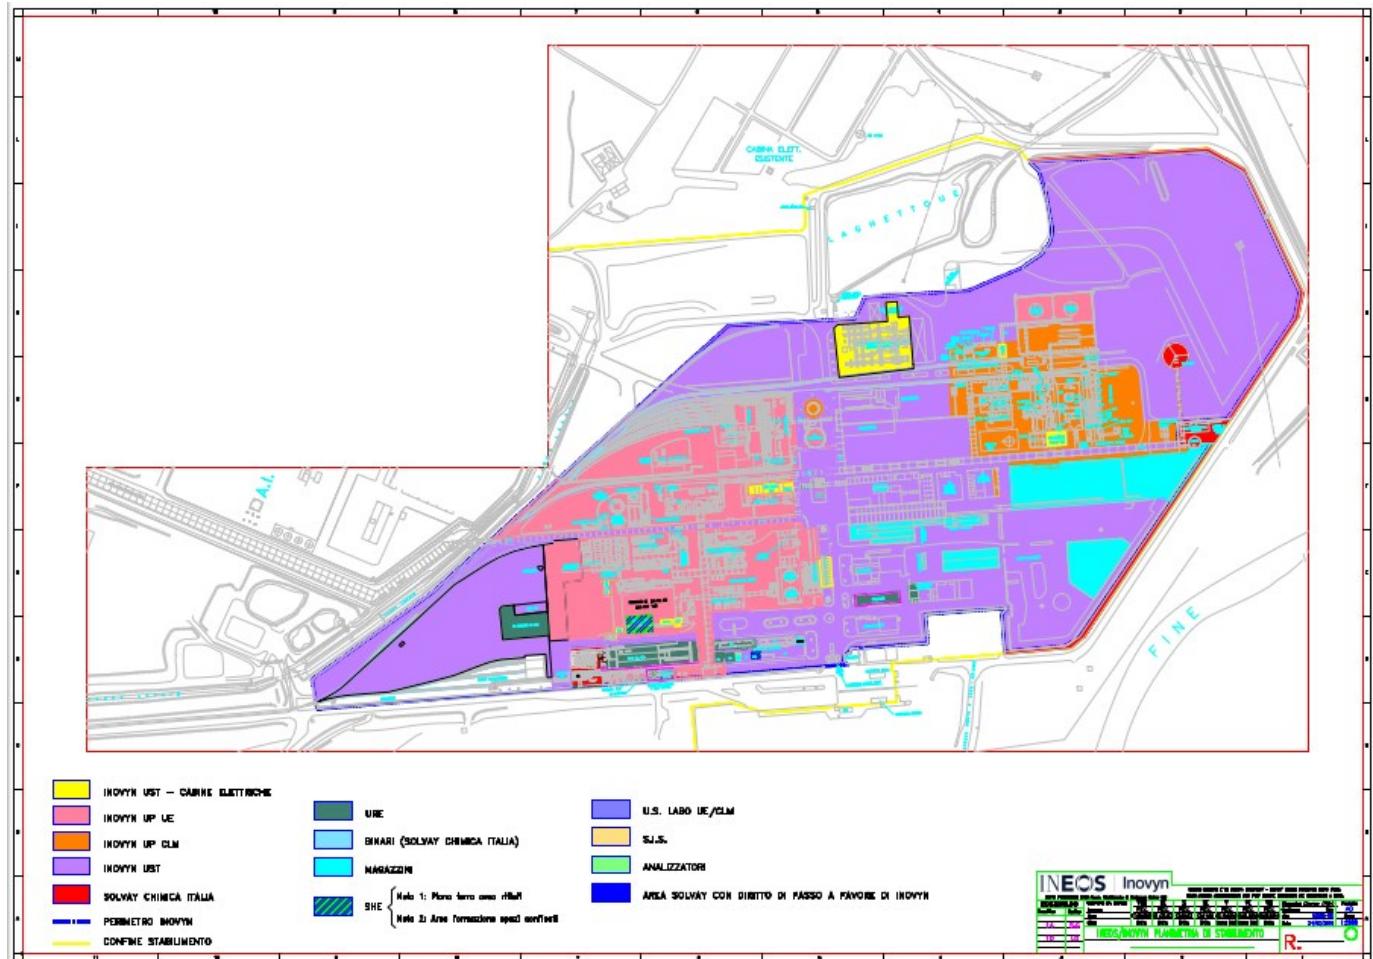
Planimetria dello stabilimento con suddivisione degli Impianti/ reparti
